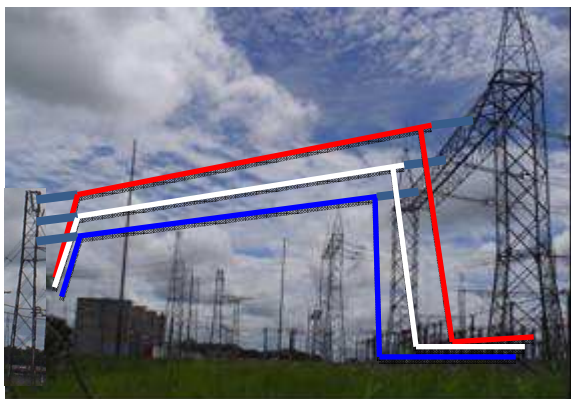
Vista do ramal conectado no pórtico de 500 kV e na torre de emergência estaiada
